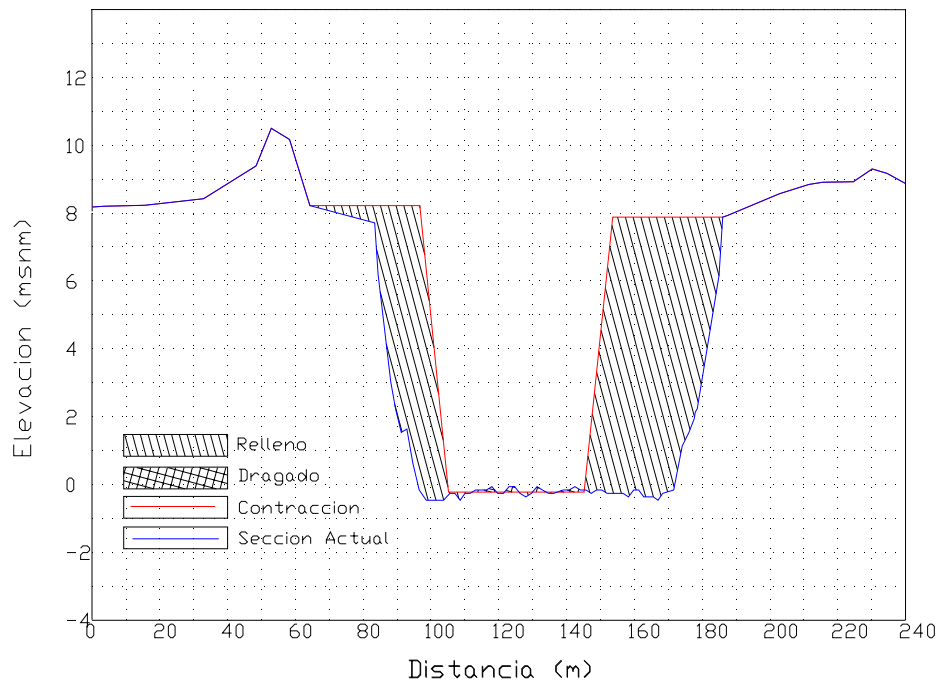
Sección transversal km 4 - Contracción No. 1
